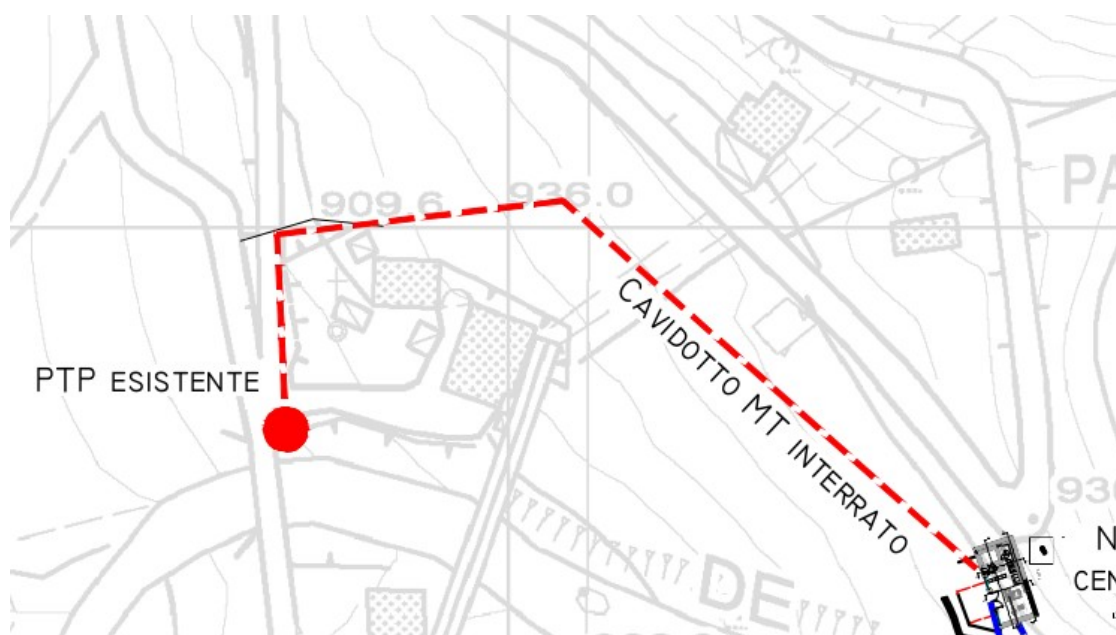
Estratto planimetrico del tracciato del cavidotto MT interrato
